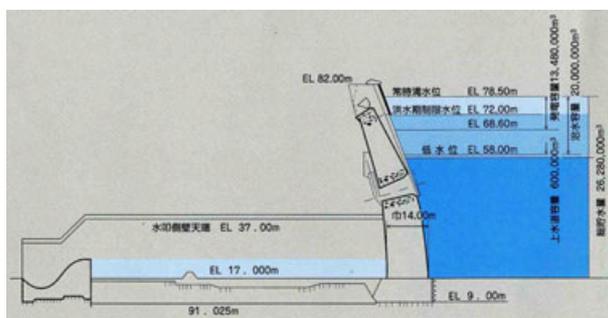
貯水池容量配分図及びダム堤体平面図
